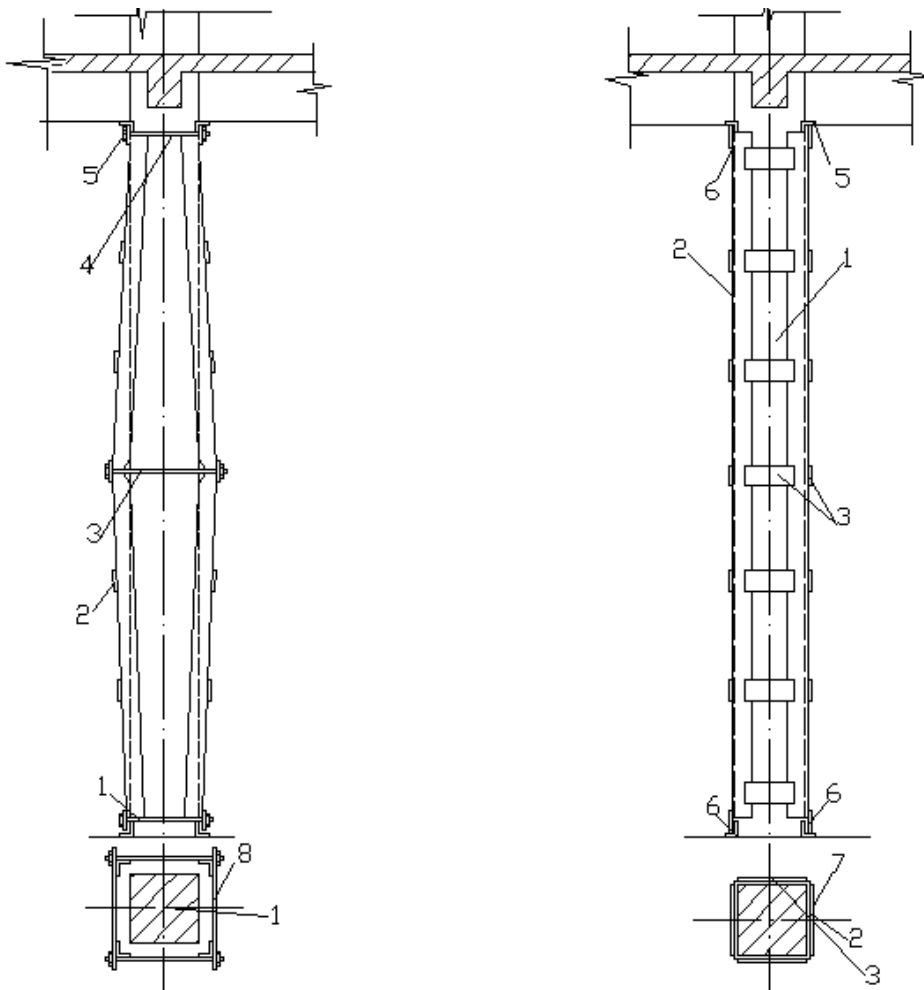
Підсилення колони попередньо напруженими двосторонніми металевими розпірками: а) установка розпірок; б) підсилення колон після монтажу; 1 – підсилювана колона після монтажу; 2 – кутники розпірок; 3 – натяжний монтажний болт; 4 – кріпильний монтажний блок; 5 – упорні кутники; 6 – планки-упори; 7 – з'єднувальні планки; 8 – планка для натягу болтів у місці перегину.
